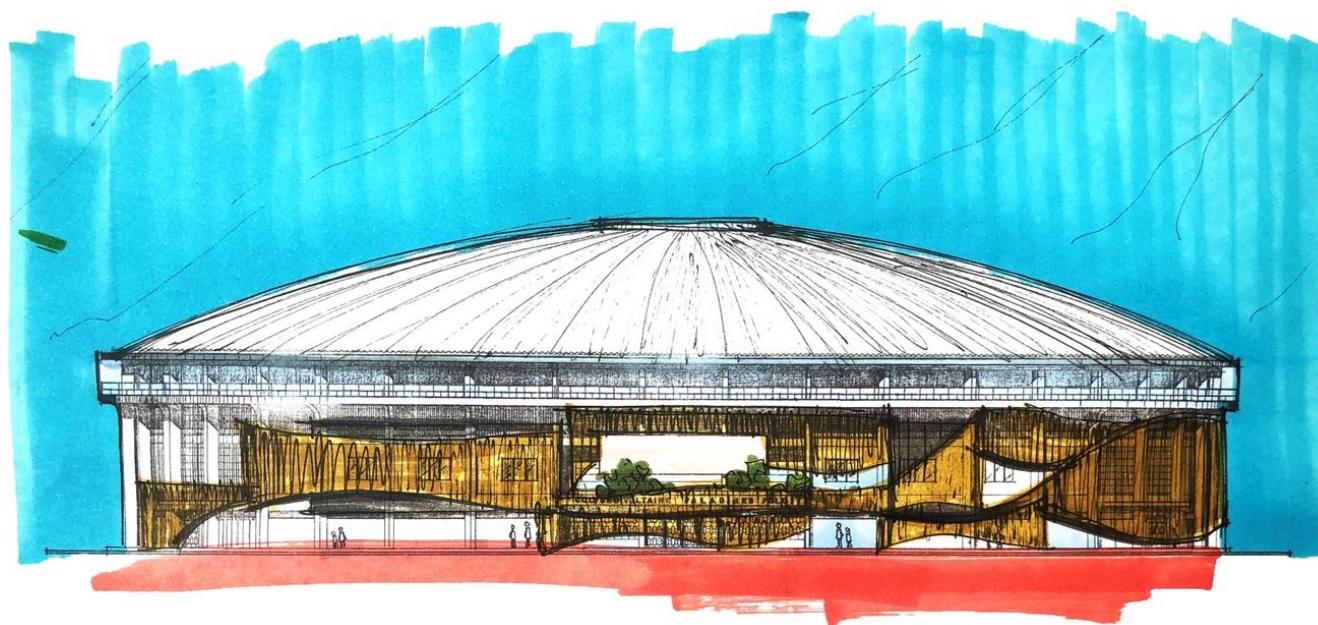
Boceto de fachada este. Fuente: Elaboración propia (2019).
